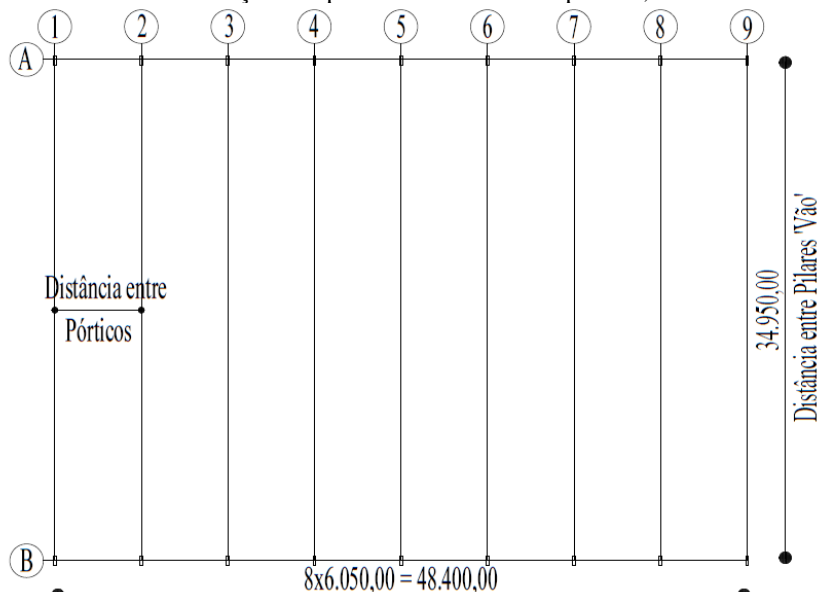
Planta de localização dos pórticos do ginásio do Gameleira, medidas em mm.
